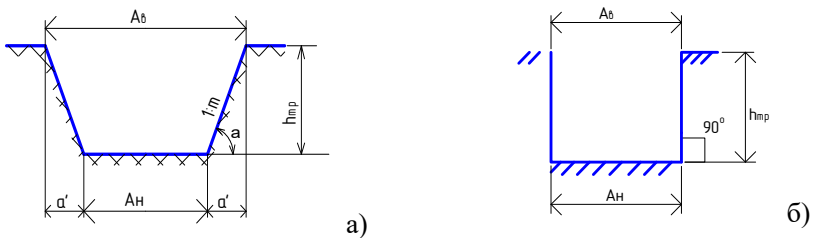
Разработка траншеи с откосами (а) и с вертикальными стенками (б)
